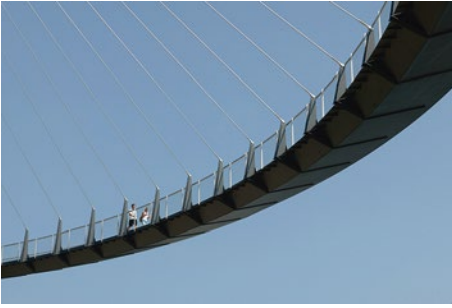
Brückenuntersicht (Foto: Wilfried Dechau)
